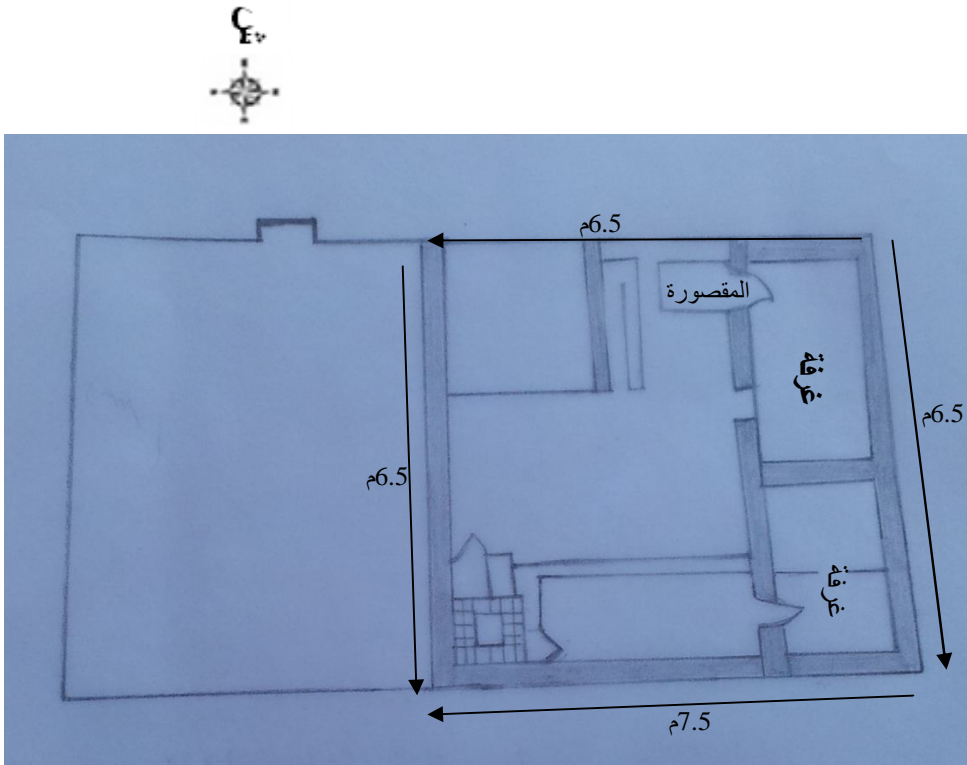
مخطط الطابق الأرضي للمسجد العتيق
